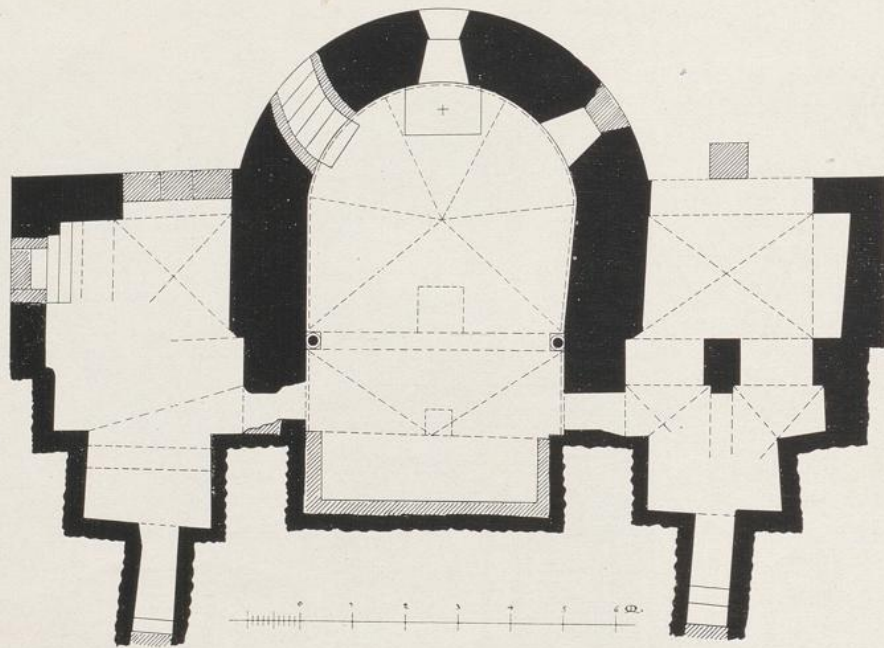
St.-Maria-Lyskirchen. Grundriss der Krypta.
